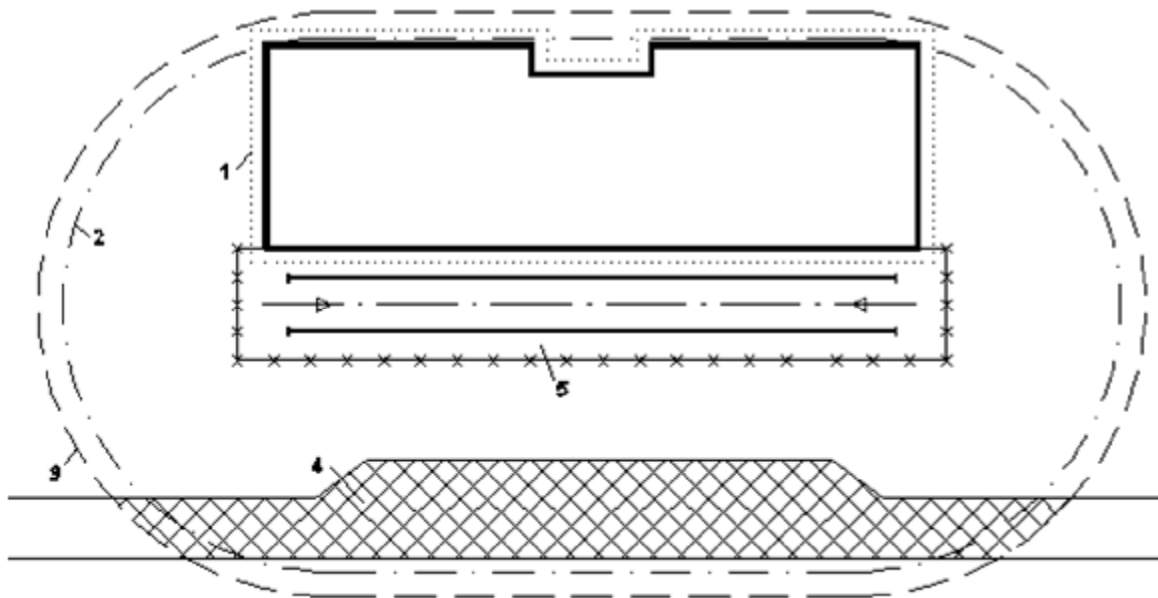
Опасные зоны при работе крана: 1 – монтажная зона; 2 – зона работы крана; 3 – опасная зона; 4 – опасная зона дороги; 5 – опасная зона подкрановых путей
